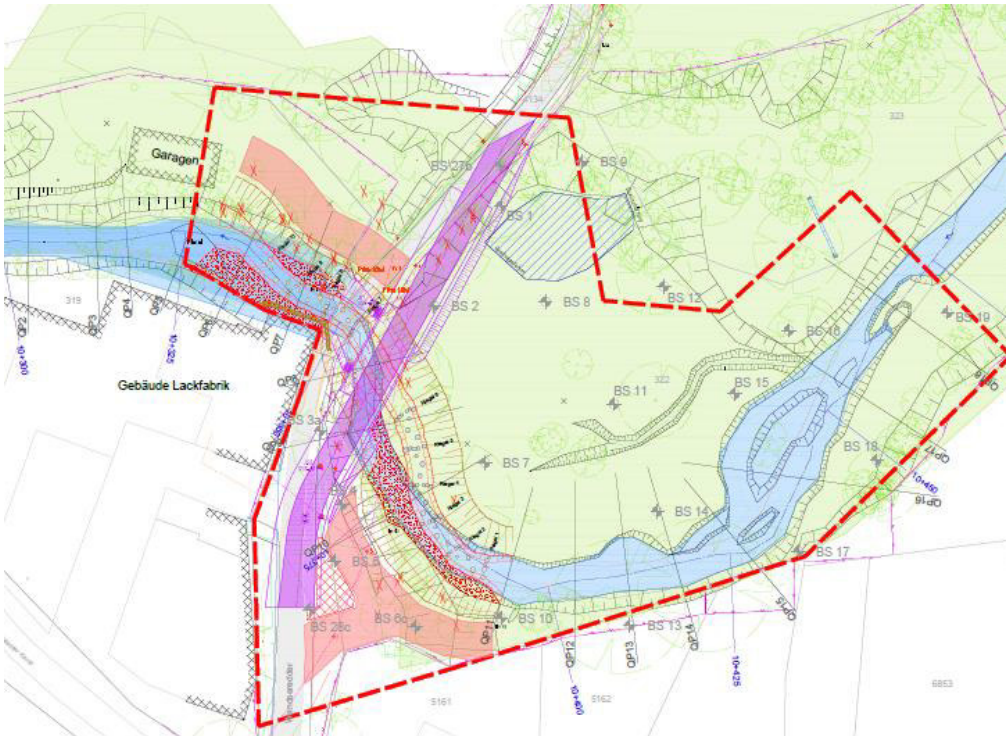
Lageplan Fischaufstiegsanlage mit Baustraßen (rosa) und Brückenneubau (lila, schematische Darstellung) u. temporärer Baugrube (braun schraffierte Böschung) (Auszug BIOTA 2021b)
